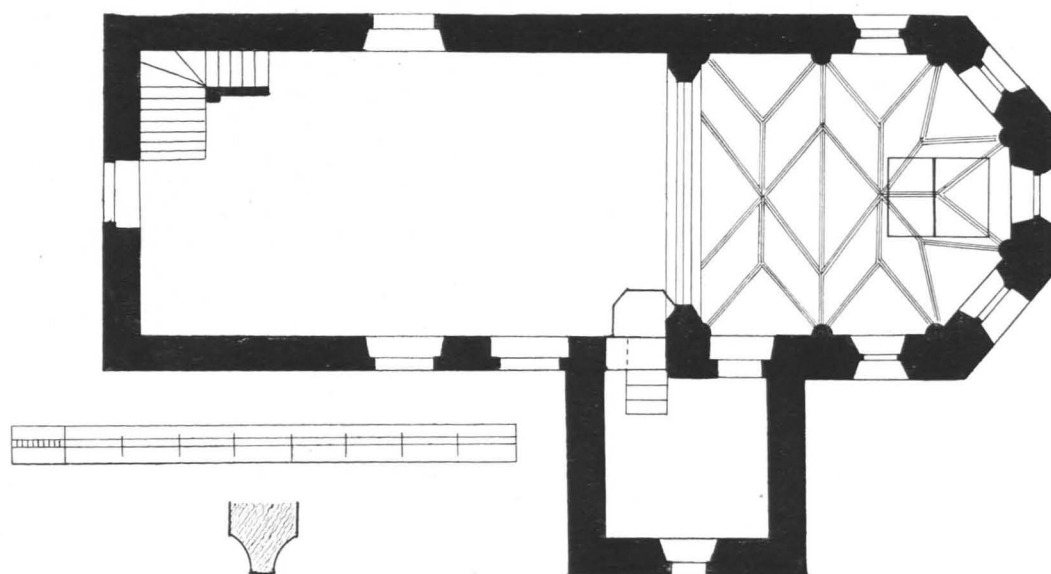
Kirchgöming, Filialkirche, Grundriß 1 : 133 (S. 464)
